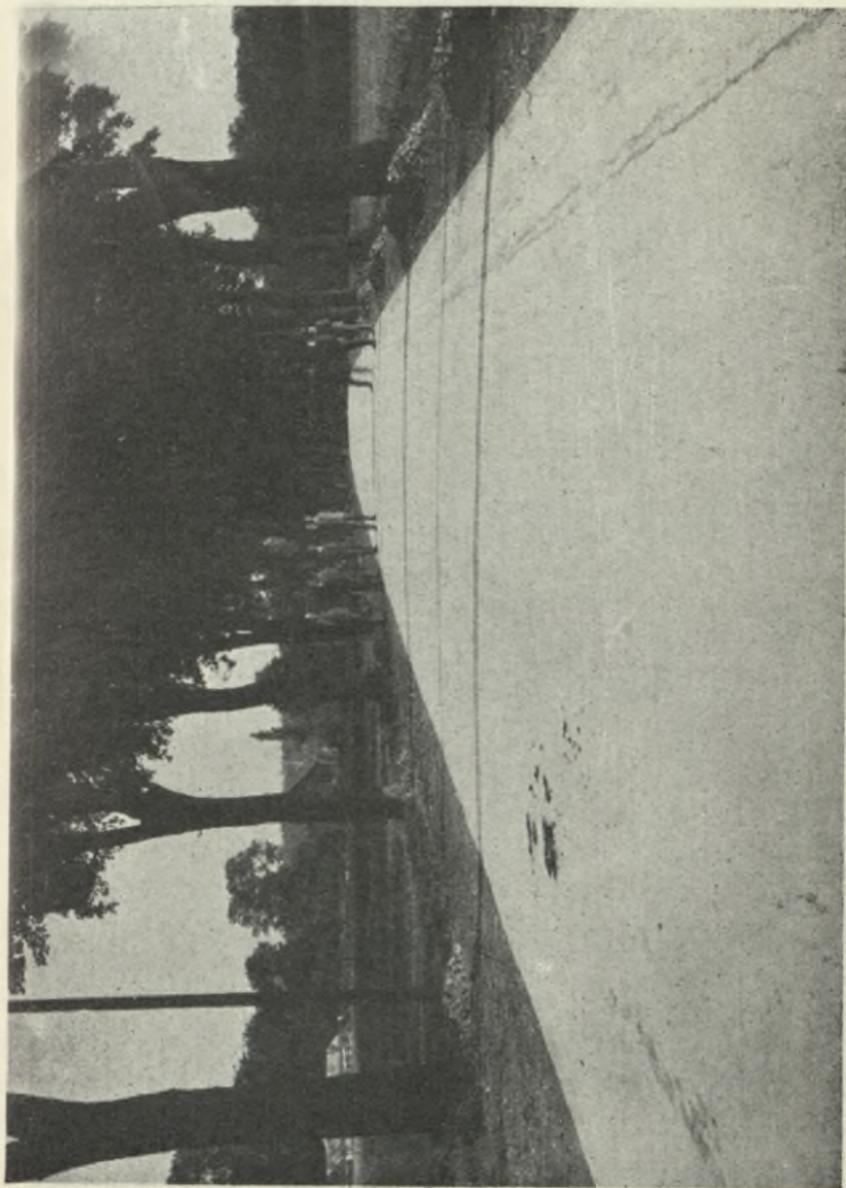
Solidität-Betonstraße bei Krummenweg bei Düsseldorf.
